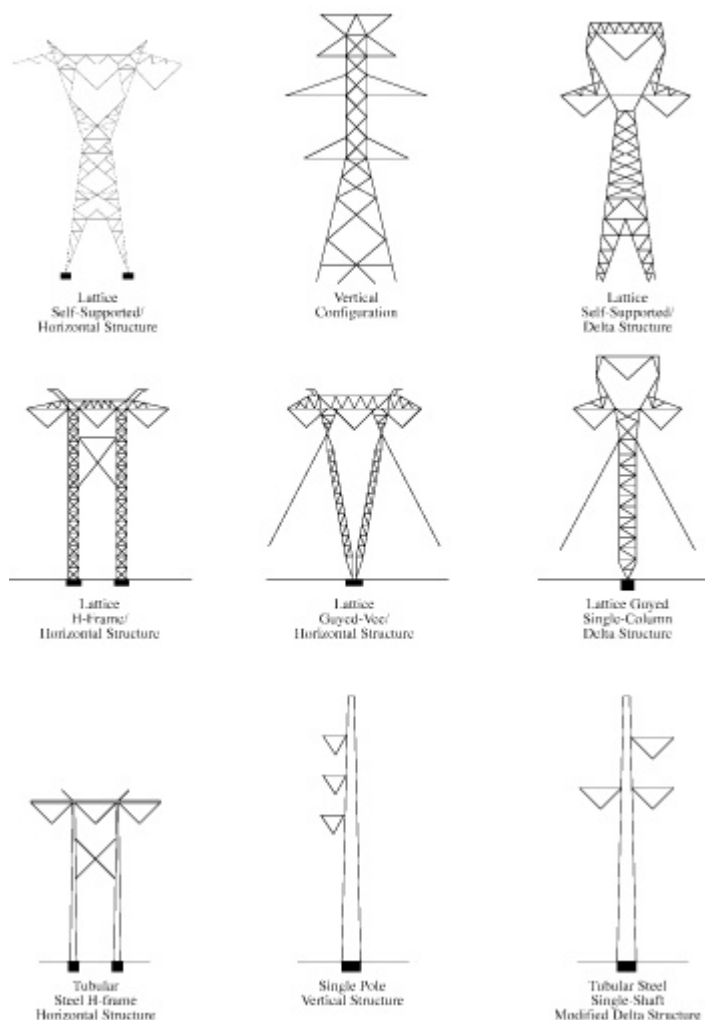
Configurações de torres metálicas e postes de alta tensão - [1]
